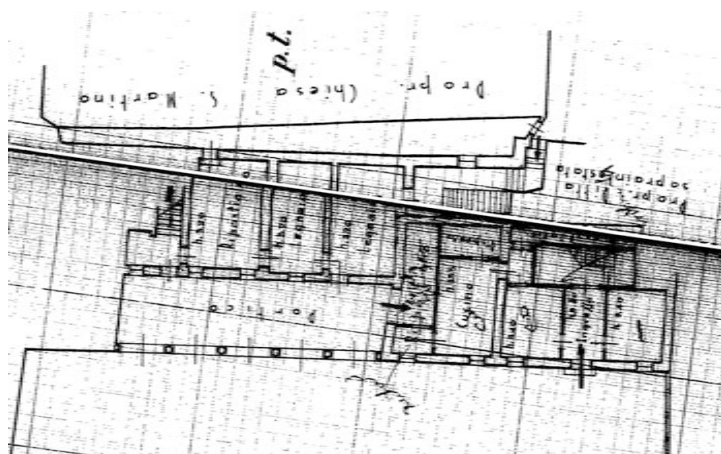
Planimetria catastale piano terra villa Rotàri-Cartolari, 1984.¹²
